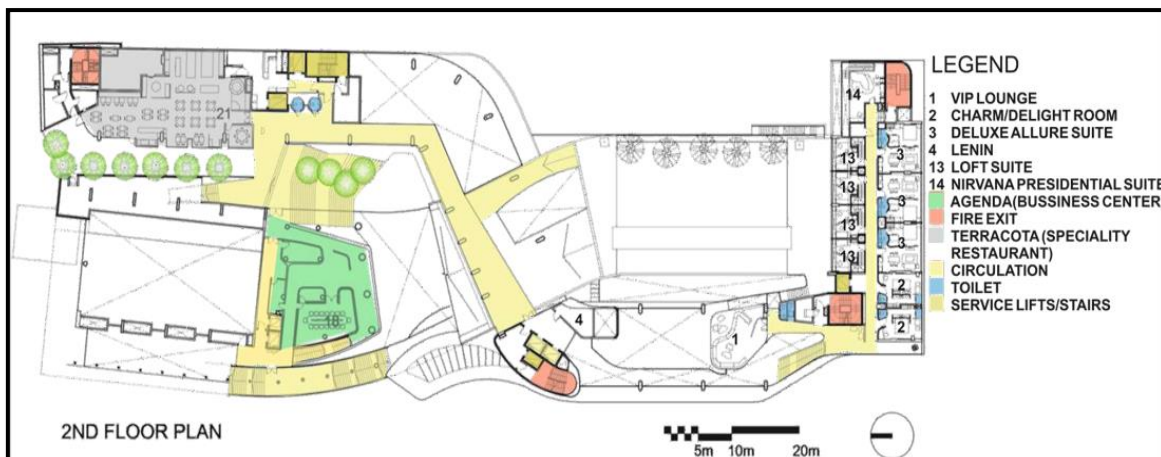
Plan du 2<sup>ème</sup> étage Hôtel Vivanta
